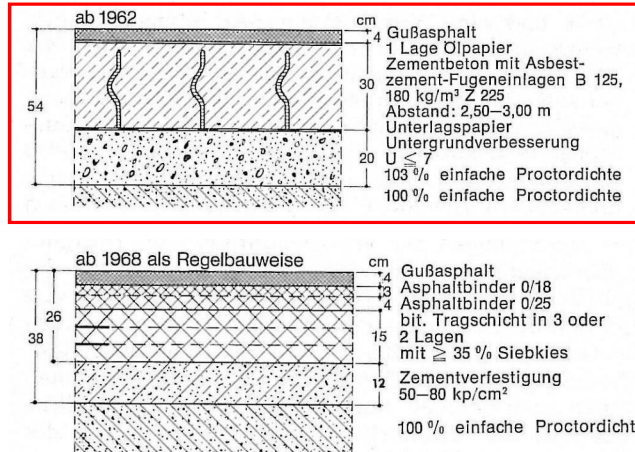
Zementbetonunterbau als sog. Streifenbeton
